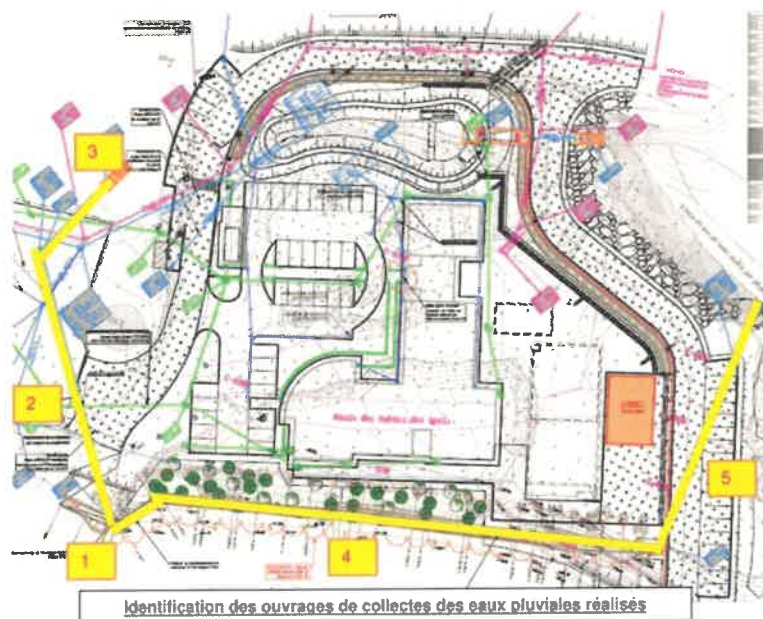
Réseau de collecte des eaux pluviales – Etablissement Géométhane - Site de Gaude
